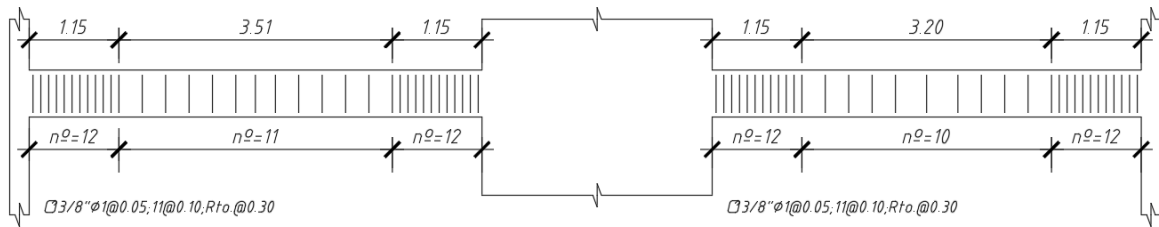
Distribución de estribos de las vigas VT-01 y VT-02
